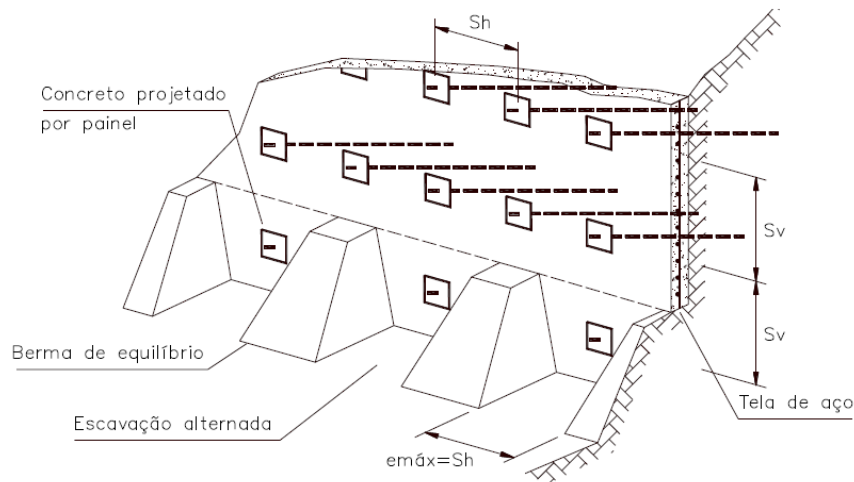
Fases típicas de execução de uma obra em solo grampeado em talude escavado (SILVA, 2009).
